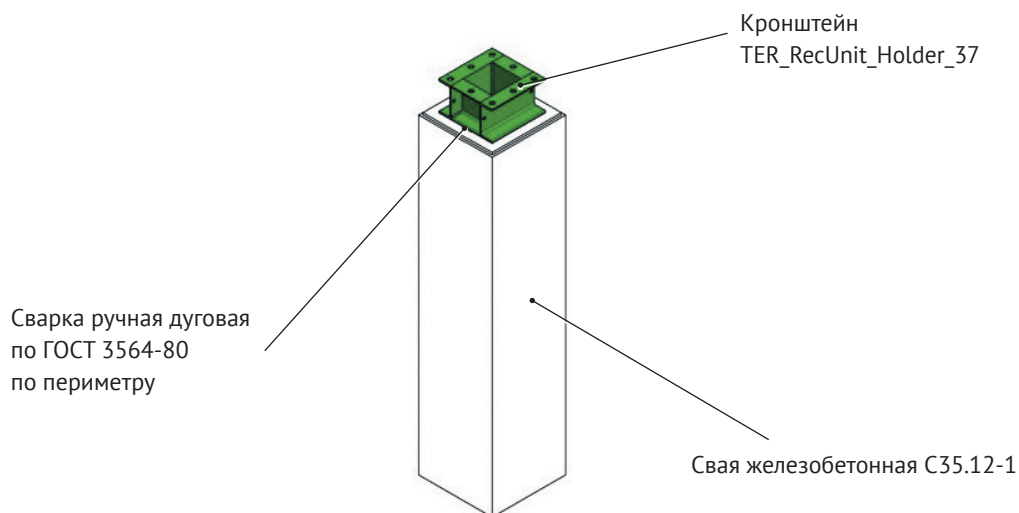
Крепление сваркой кронштейна к металлическому оголовку сваи типа С35
